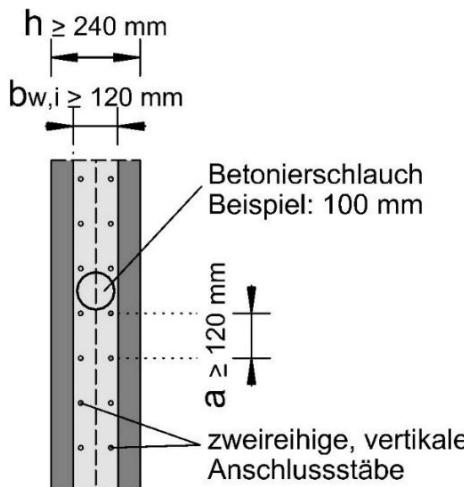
Mögliches Einbringen eines Betonierrohrs in eine Elementwand mit Wanddicke von 240 mm bei zweireihiger Anschlussbewehrung aus einzelnen vertikalen Bewehrungsstäben mit Mindestabstand in Wandlängsrichtung
